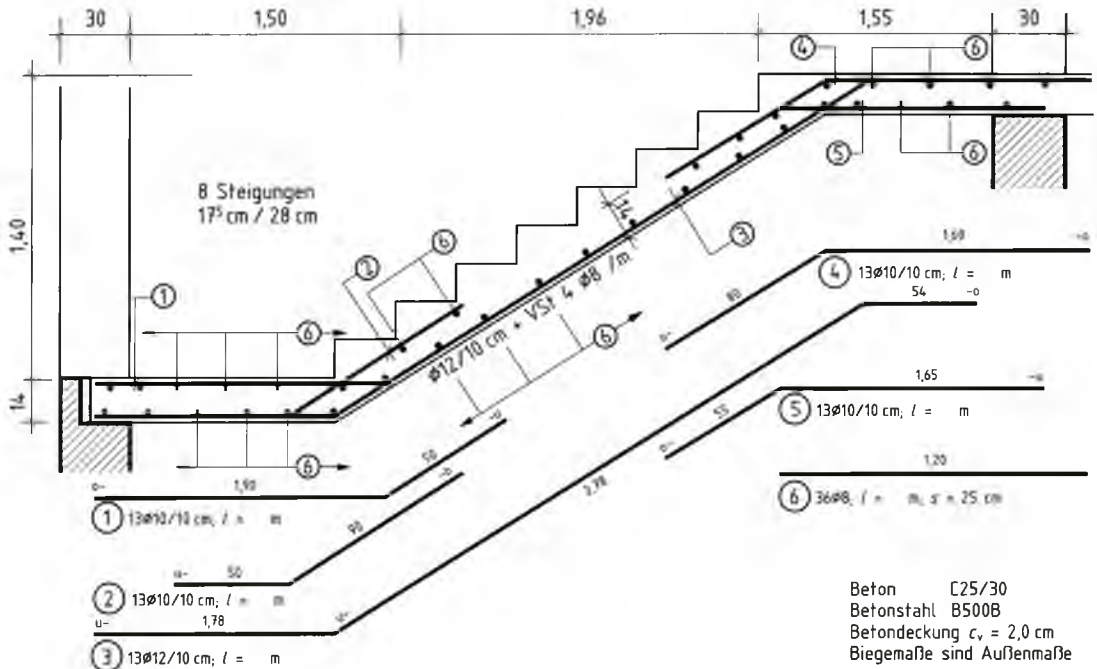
/1: Ausgleichstreppe (Bewehrungsplan)
